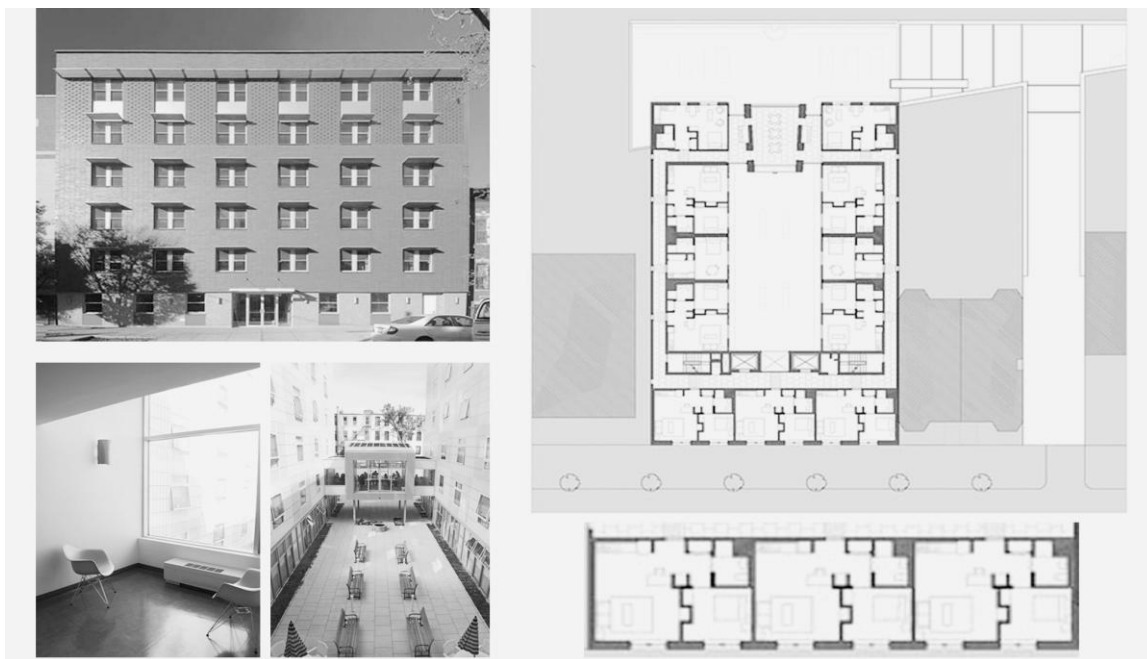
Головний фасад та планувальна схема Блоку Домнік (Domenech) у Браунсвіллі
